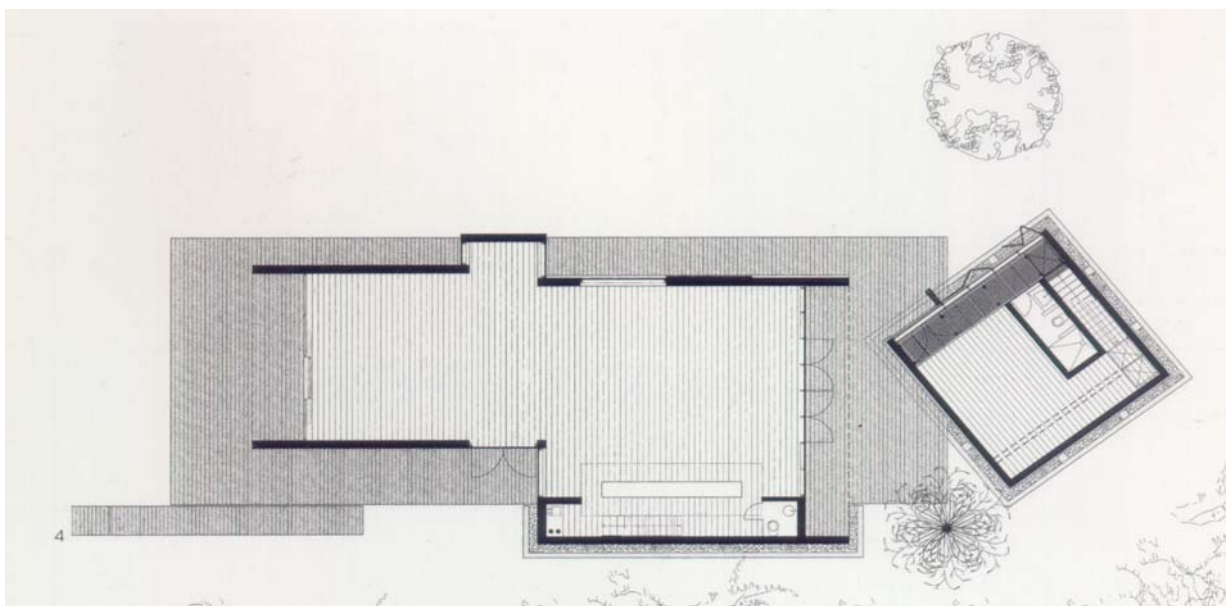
House and Office* –planta. Fonte: Stungo (1998)
